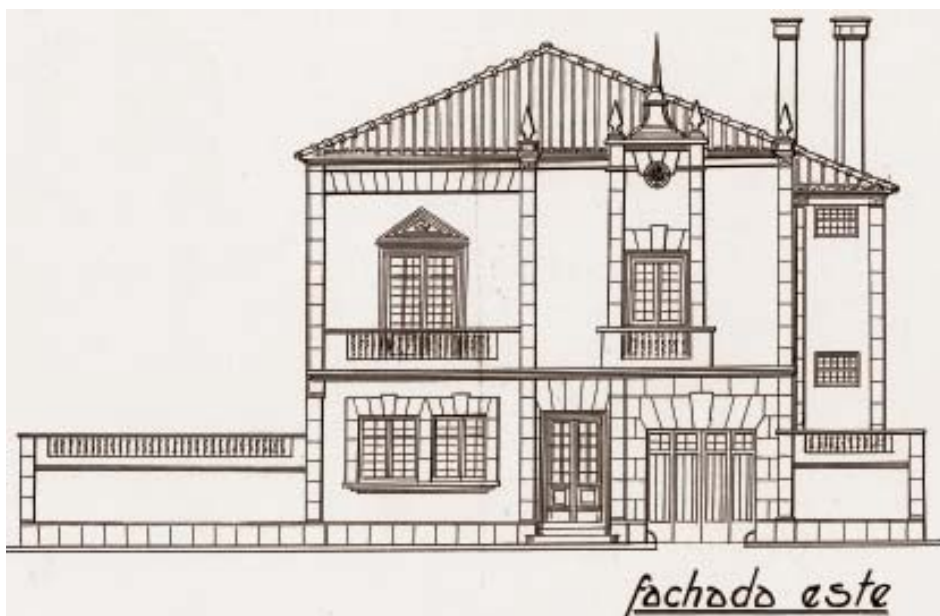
Fachada Este del edificio proyectado en avenida Jesús García Naveira, Betanzos, 1939.
